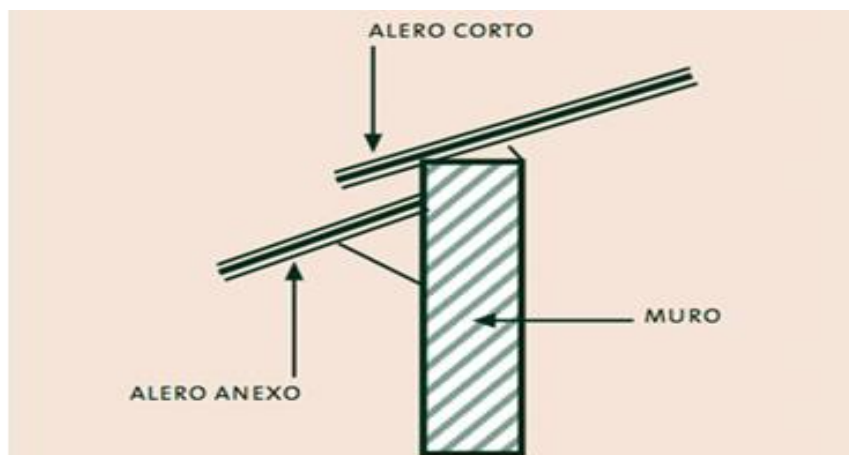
Alero en muro. Recuperado de Arrevol (2016).
